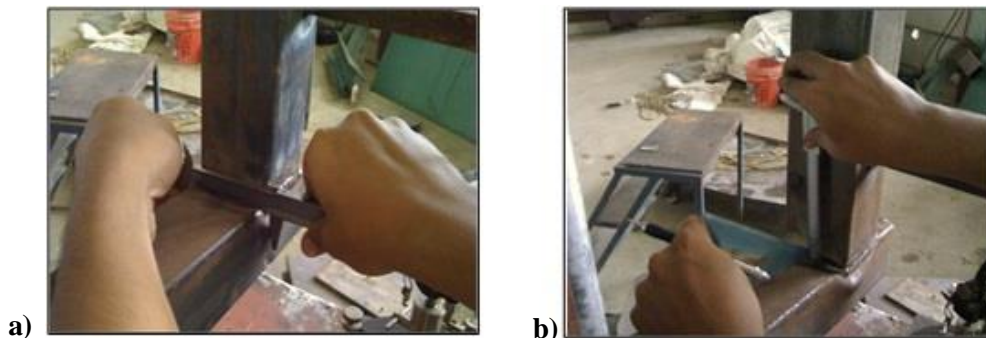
a) Ensanchamiento de la sección transversal de la columna del pórtico (b1), b) Profundidad del pandeo local de la sección transversal de la columna del pórtico (b2) Fuente: [8]
